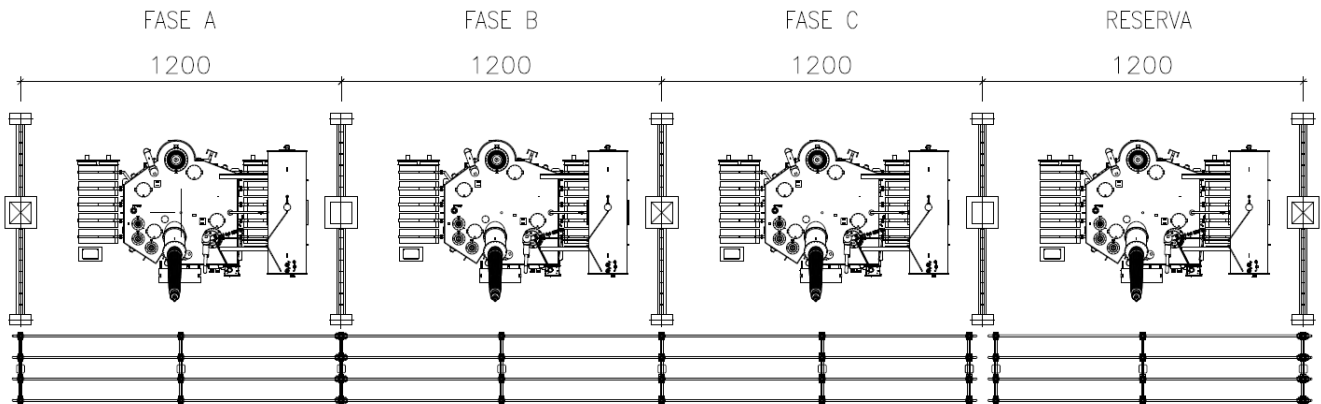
Disposición en planta de banco de autotransformadores 400/230/13.8 kV, compuesto por tres fases y una unidad de reserva con seccionamiento de barras.
